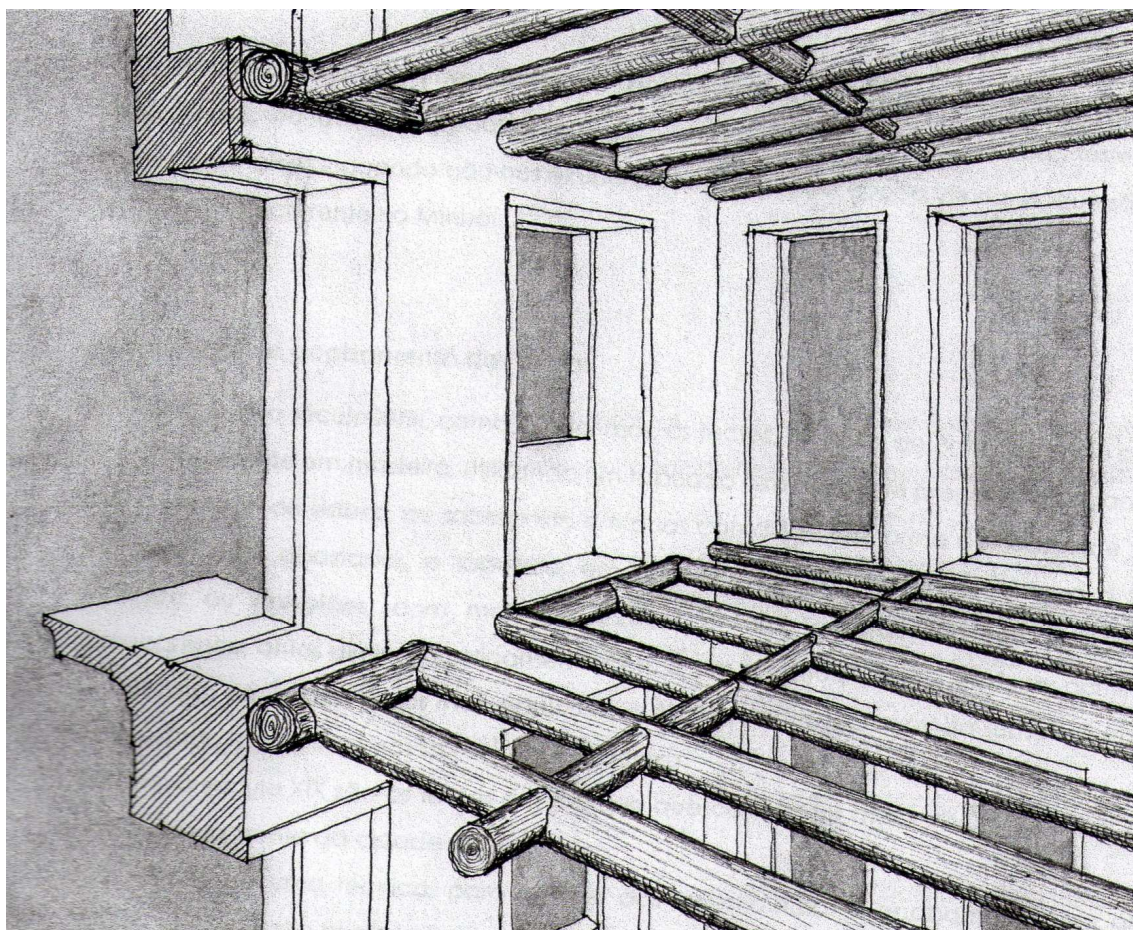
Visualização da colocação de uma viga, junto da parede da fachada principal (Teixeira, 2004, p. 91).
